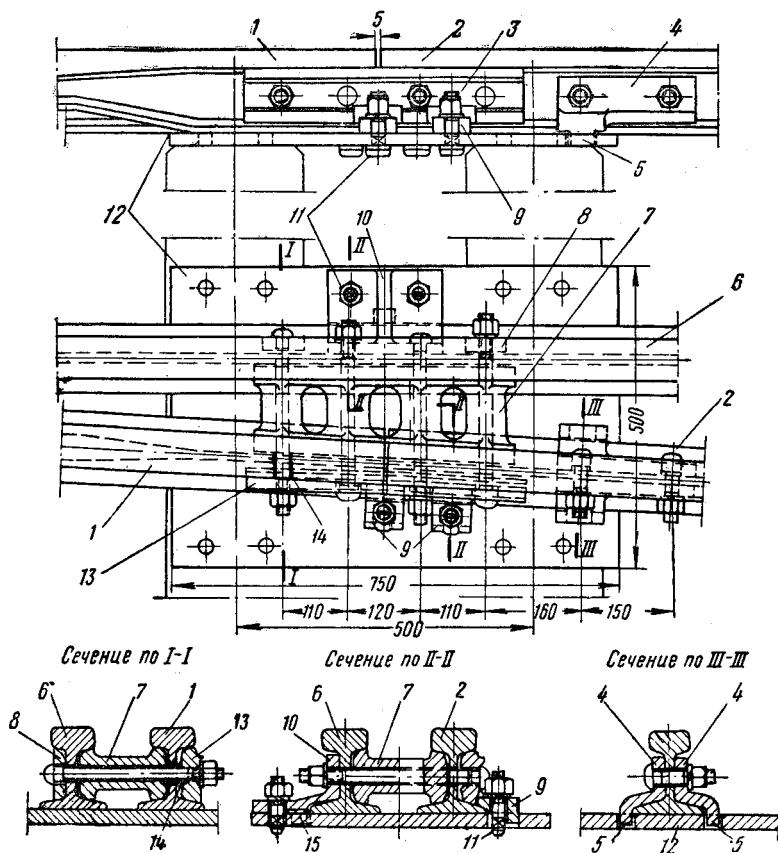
Корневое накладочное крепление остряка с выпрессованным корнем:
